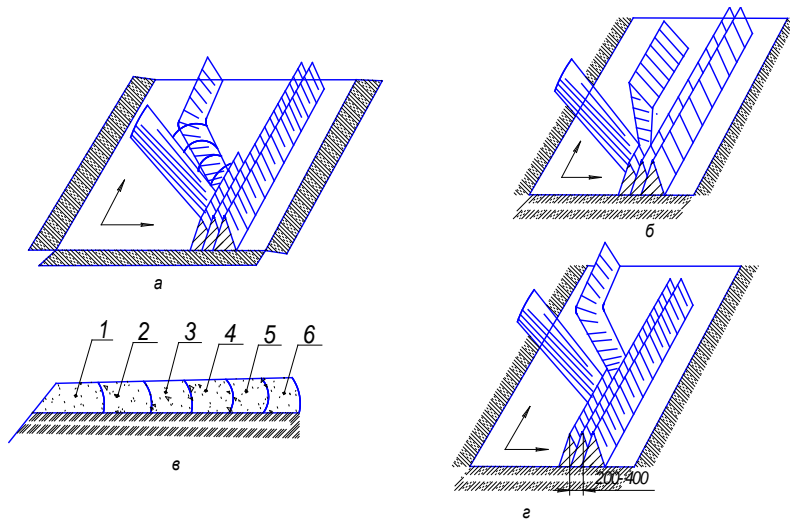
Схемы укладки валиков грунта в теле насыпи:
